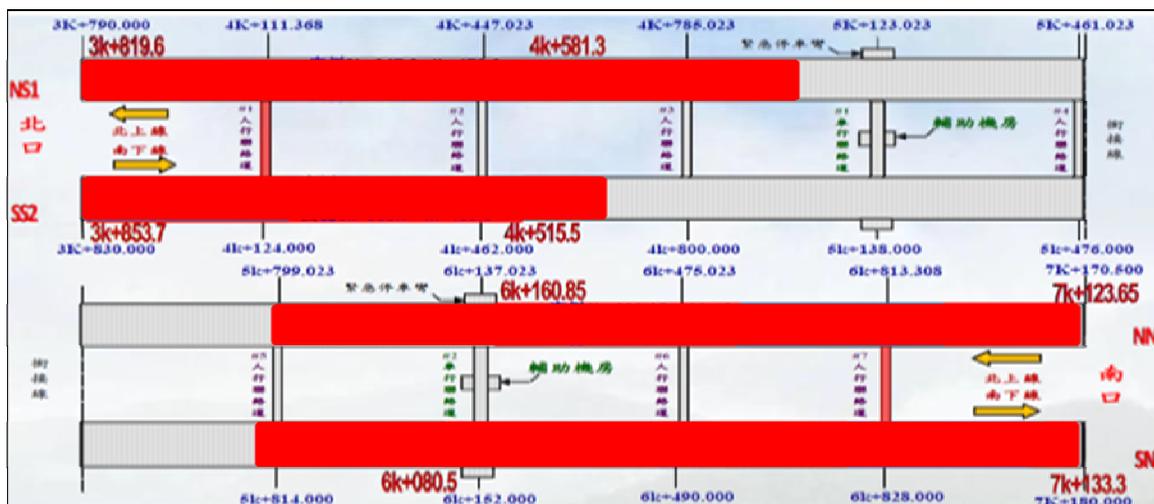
東澳隧道新建工程(A2 標)施工進度
